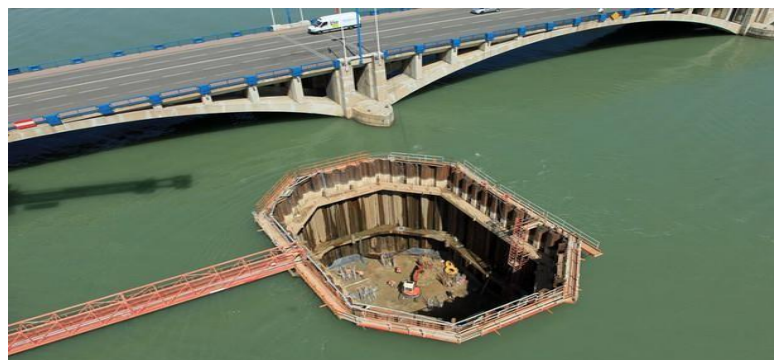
Rideaux de palplanches(Adrien Lafond 2012)
